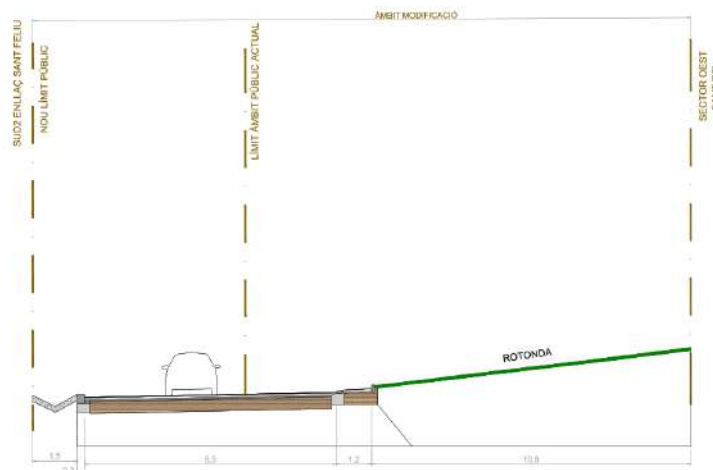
Seccions de la rotonda inserida en la MP del POUM.
